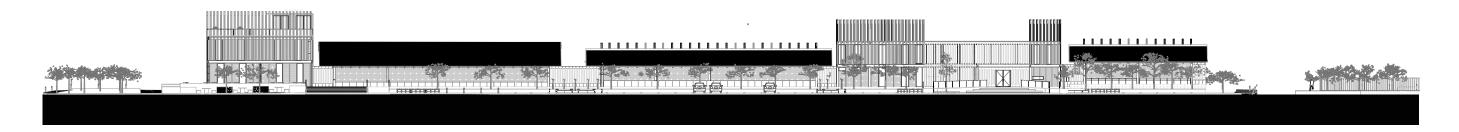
Fachada Administración Fuente: Elaboración propia 2023.
